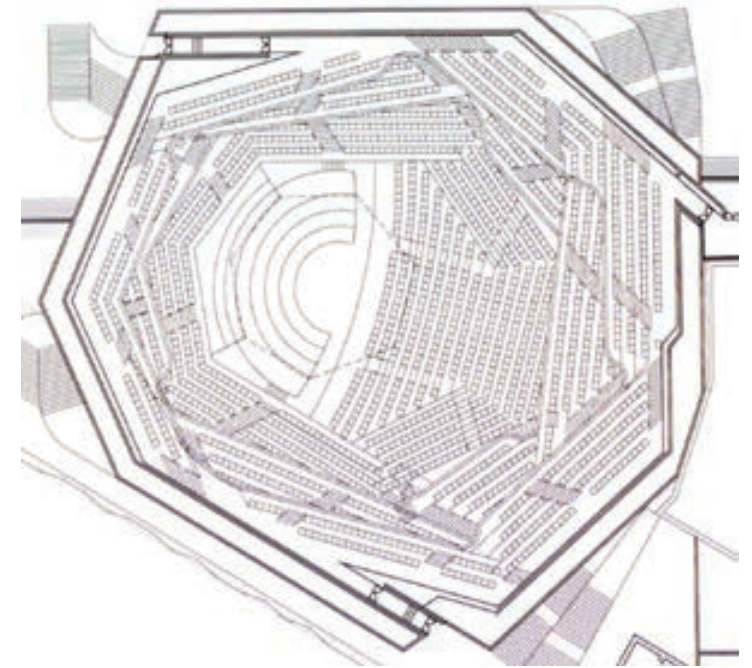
Elbphilharmonie Hamburg Grundriss
